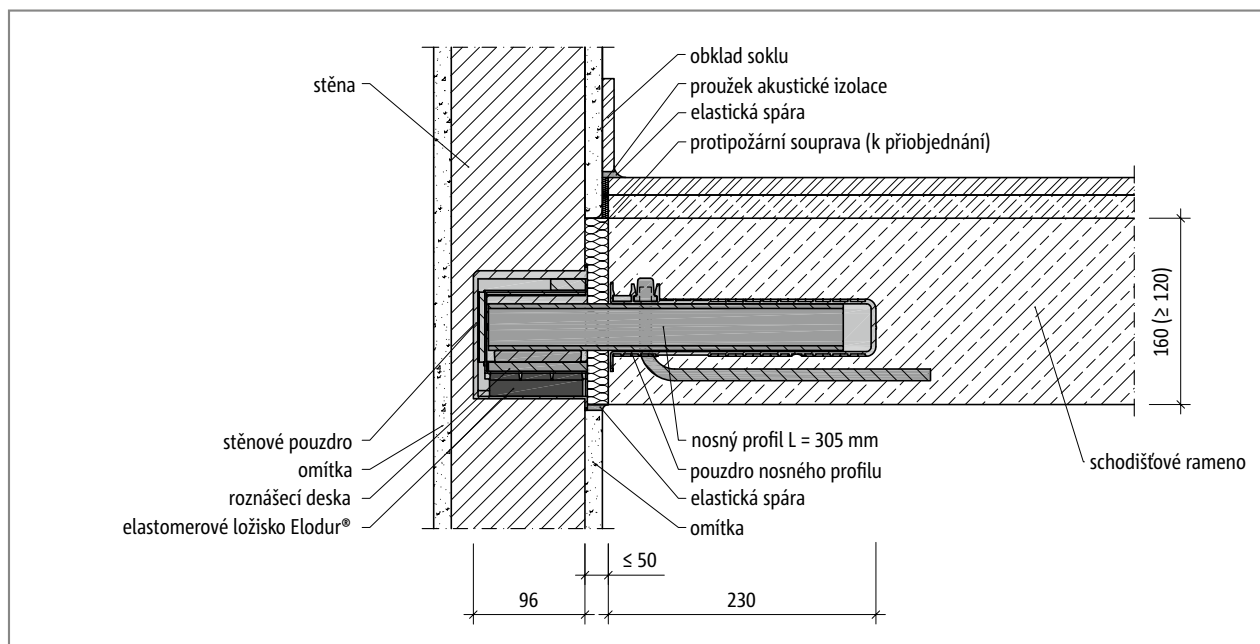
Schöck Tronsole® typ Q: Zabudování při tloušťce desky $h \geq 140$ mm se zřetelem na krytí výztuže C_{nom}
